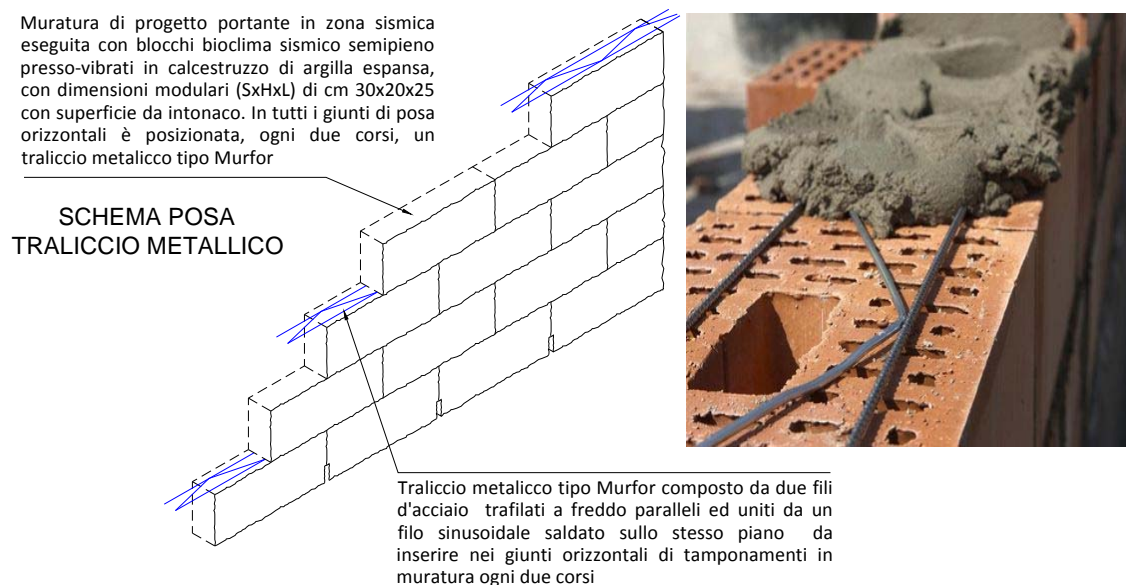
schema di posa traliccio metallico tipo Murfor
